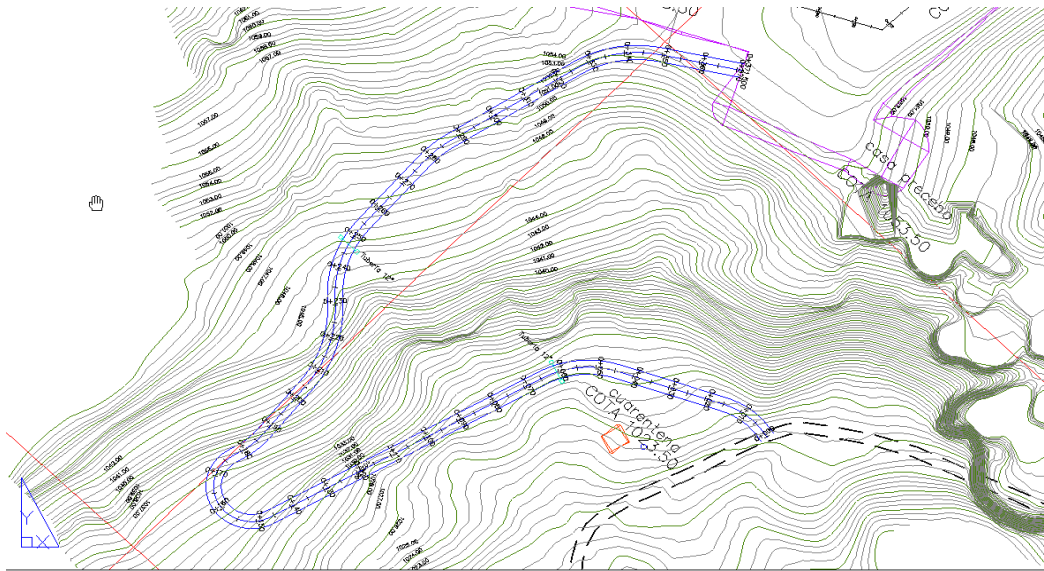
Detalle en planta del trazado de la nueva vía proyectada.
